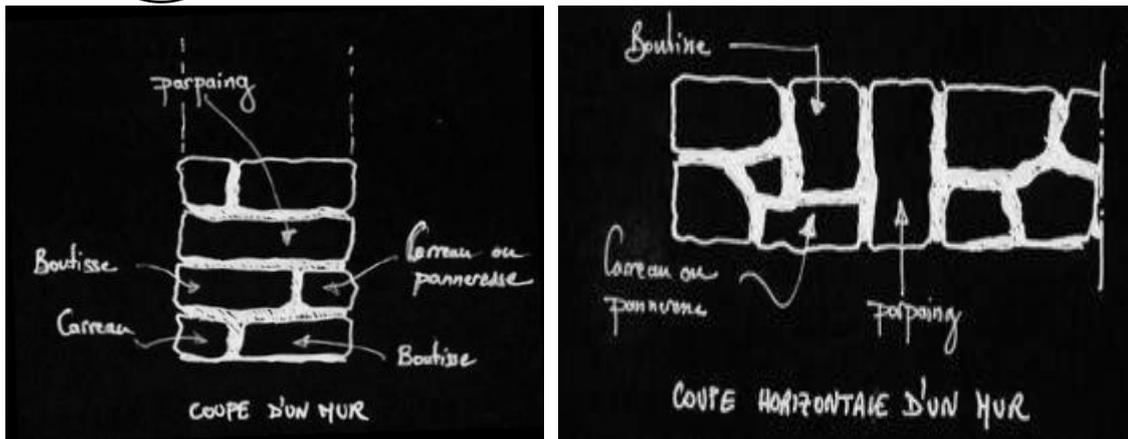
coupe verticale et horizontale respectivement en pierre moellon (source : construction de maçonnerie)
